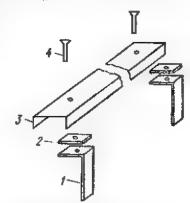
Опорный каркас для крепления металлопокрытия. 1— лапка, 2— асболертон, 3— планка, 4— заклепка
